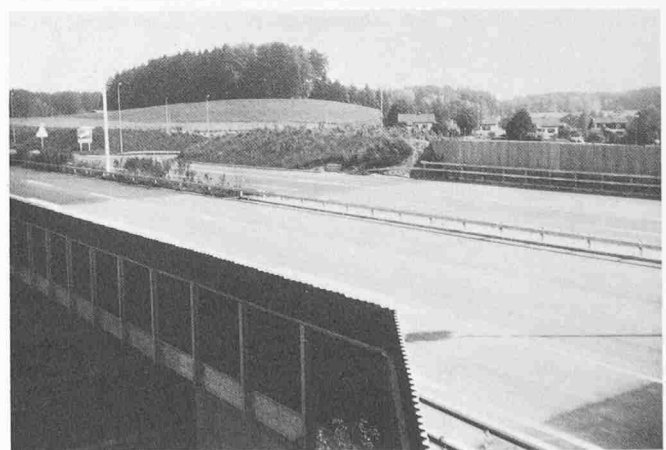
Brücke mit Schutzwänden und Erdwalle an der Umfahrung Rütli
